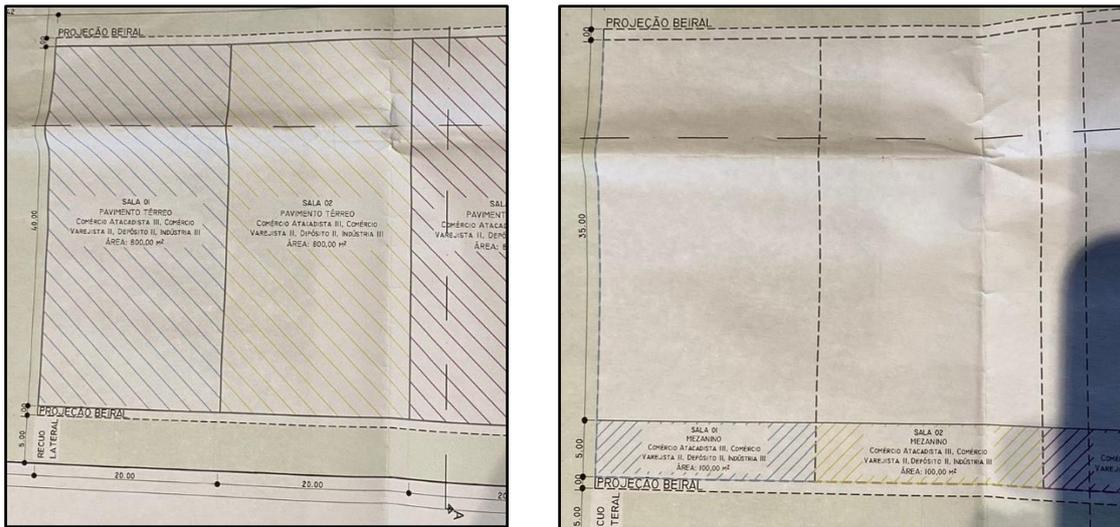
Planta Sala Comercial 02 (Térreo + Mezanino)
